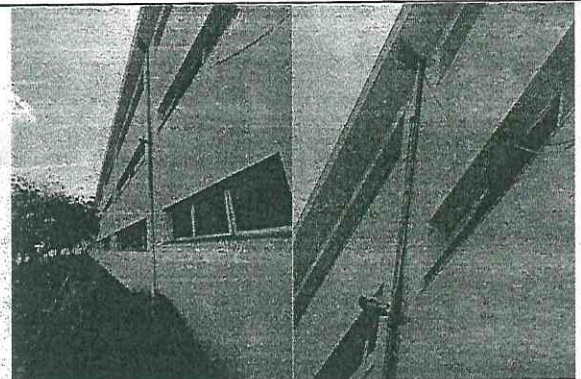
Parede com manchas de infiltração por capilaridade.
